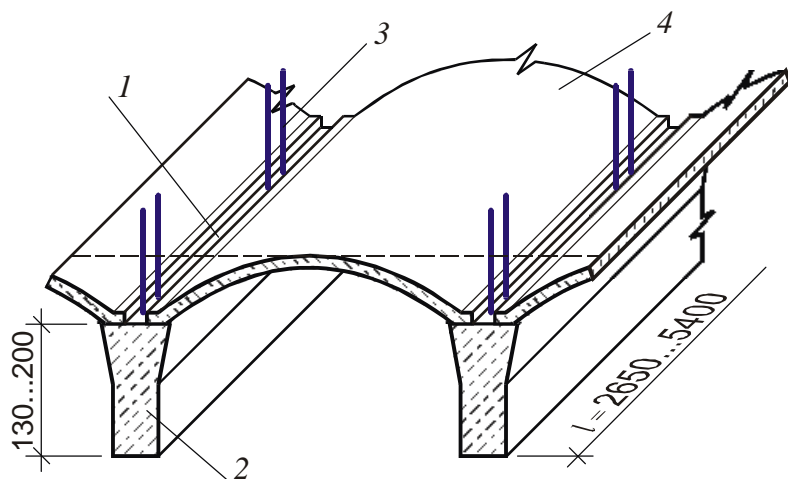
Сборно-монолитная конструкция перекрытия:
